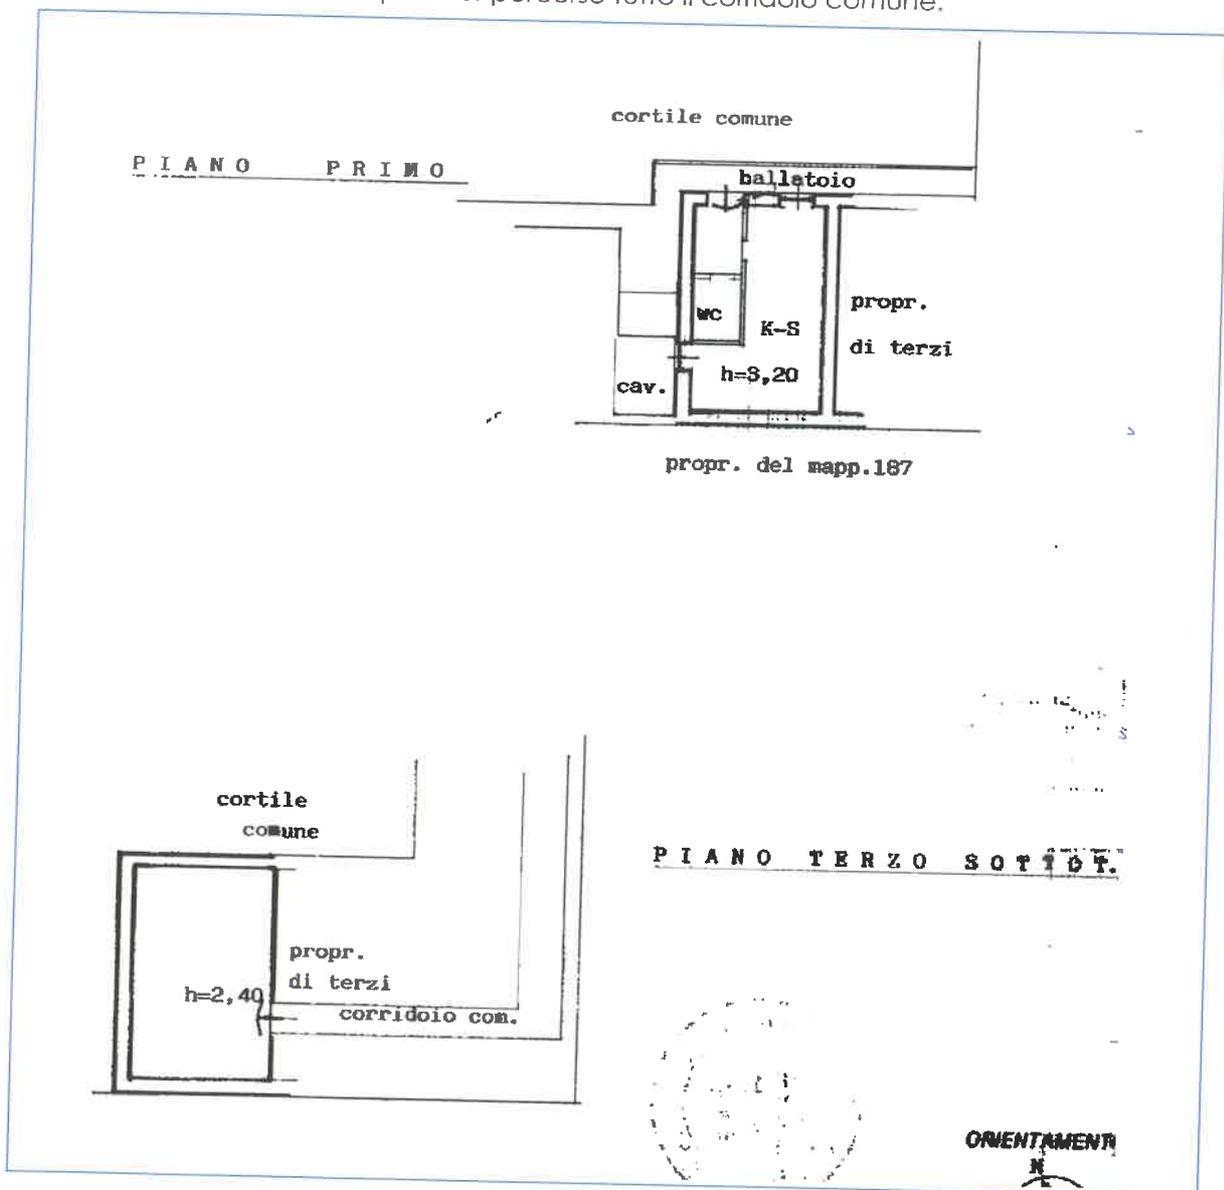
estratto planimetria catastale dell'appartamento e solaio, sub. 276 - piano 1° e sottotetto
